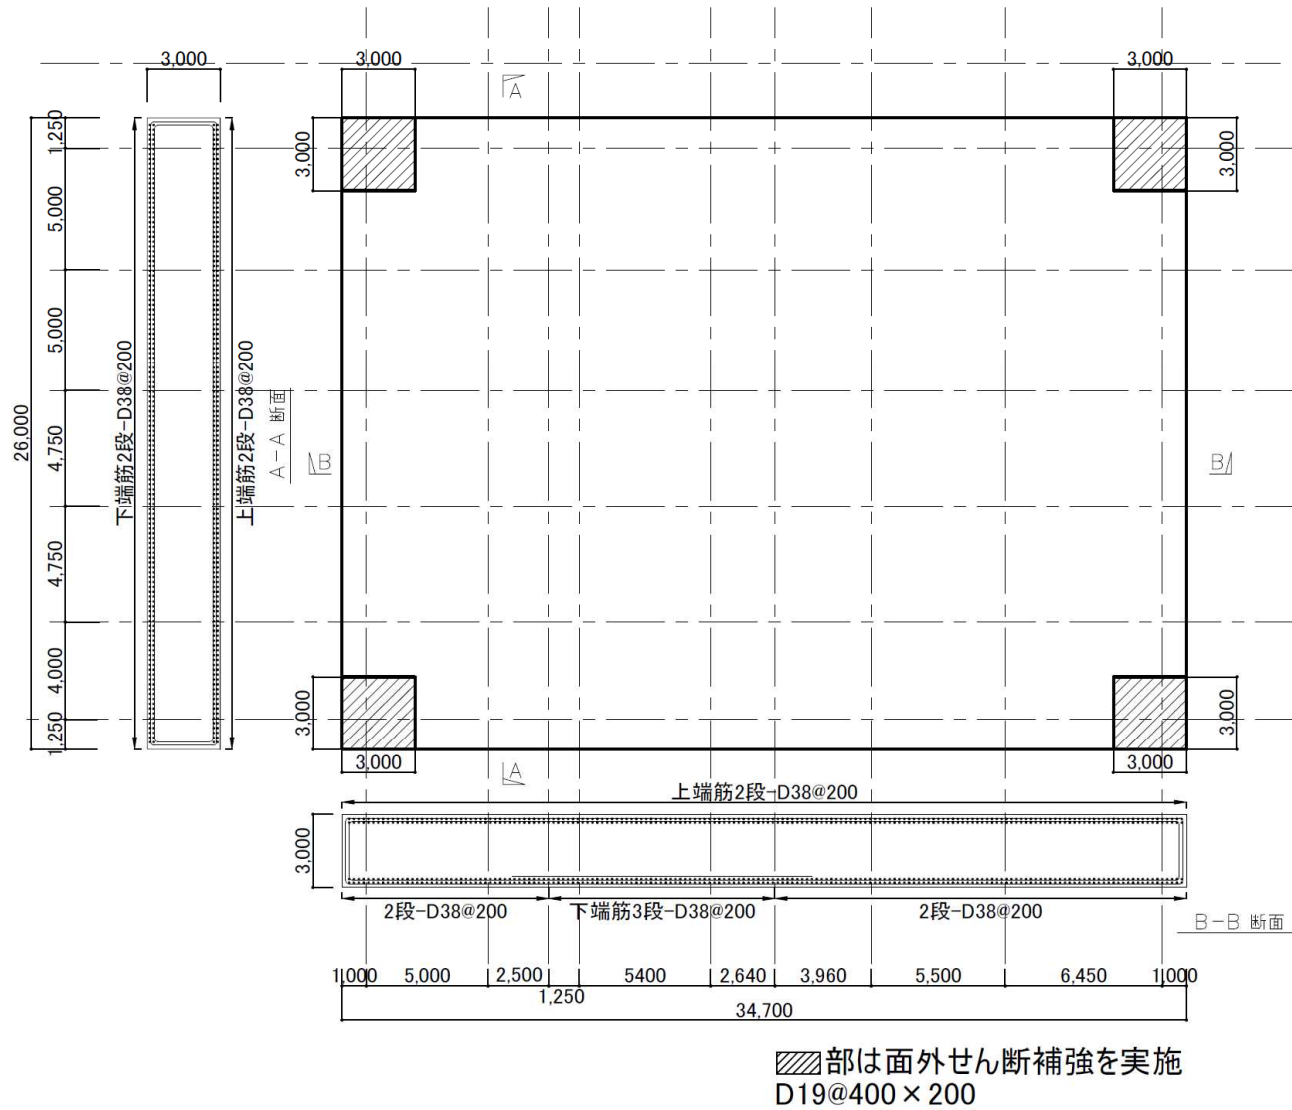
基礎の配筋図 (単位 : mm)
